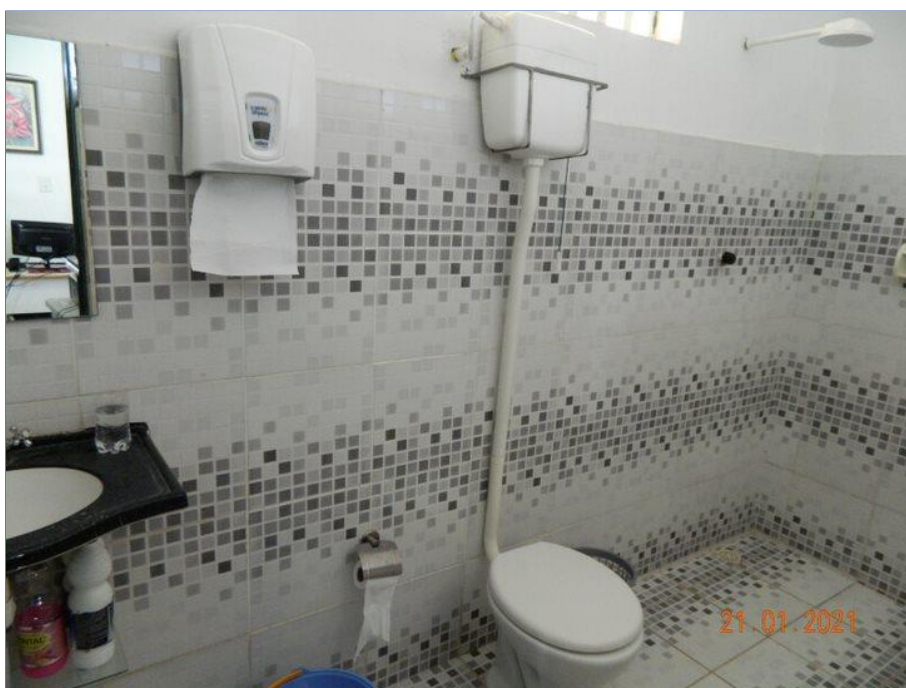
Vista geral: Parede anterior do banheiro da secretaria.
